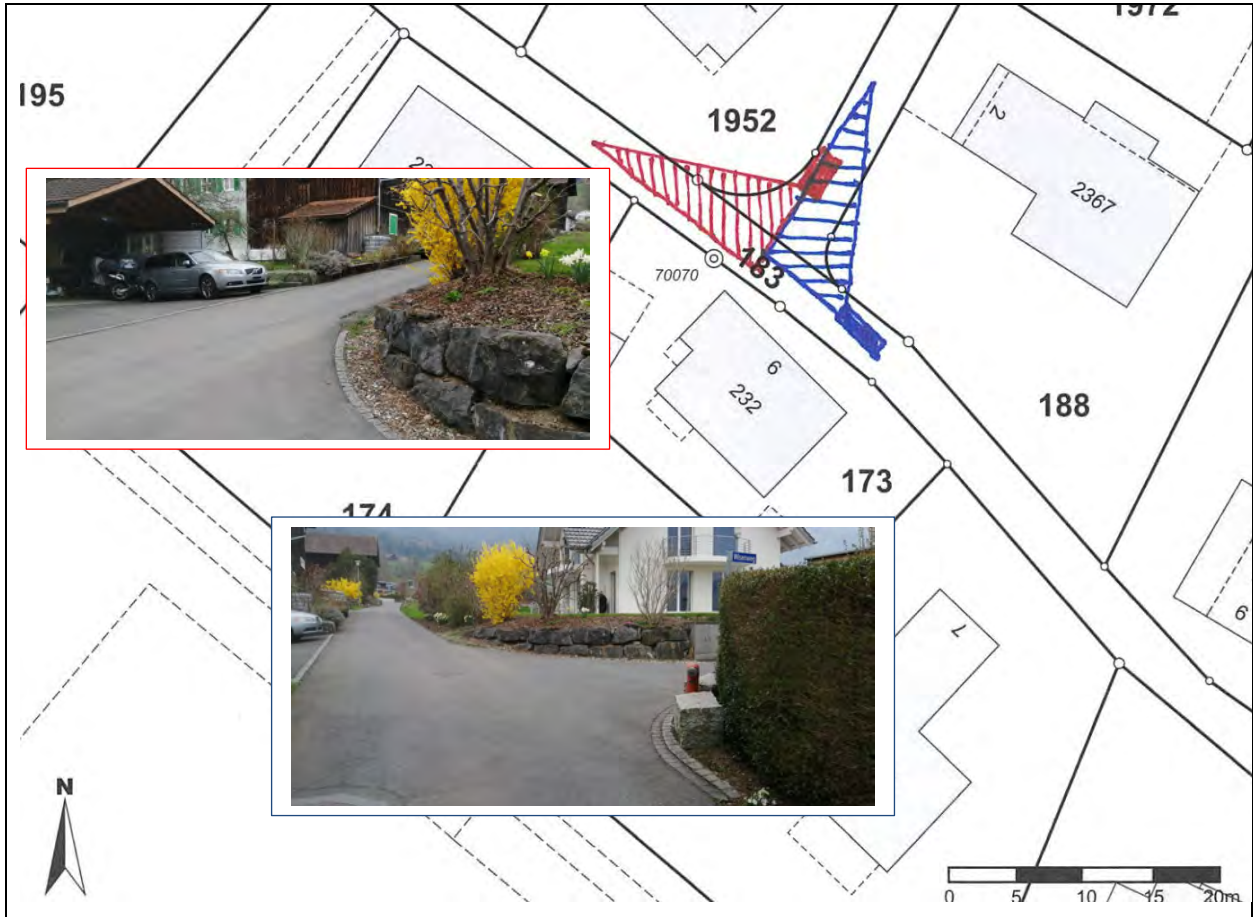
Sichtfelder an der Einmündung Schleipweg-Wisenweg
